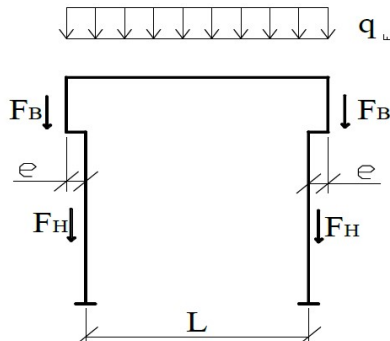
Схема приложения постоянной нагрузки к поперечной раме
